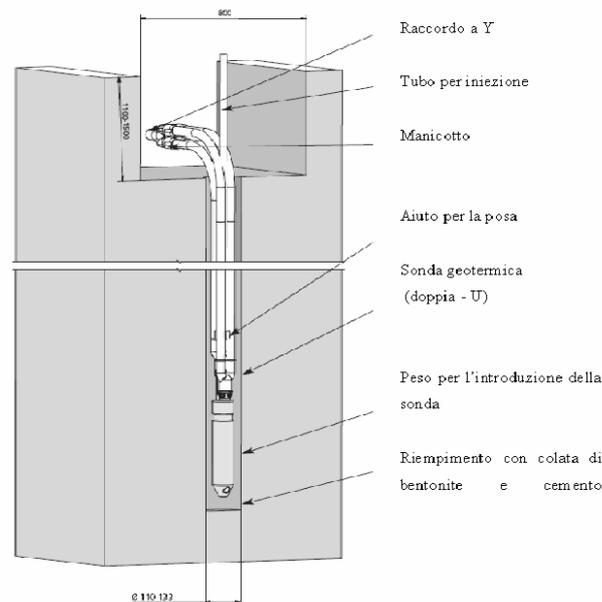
Sonda geotermica verticale del tipo a "doppia-U" [13]
